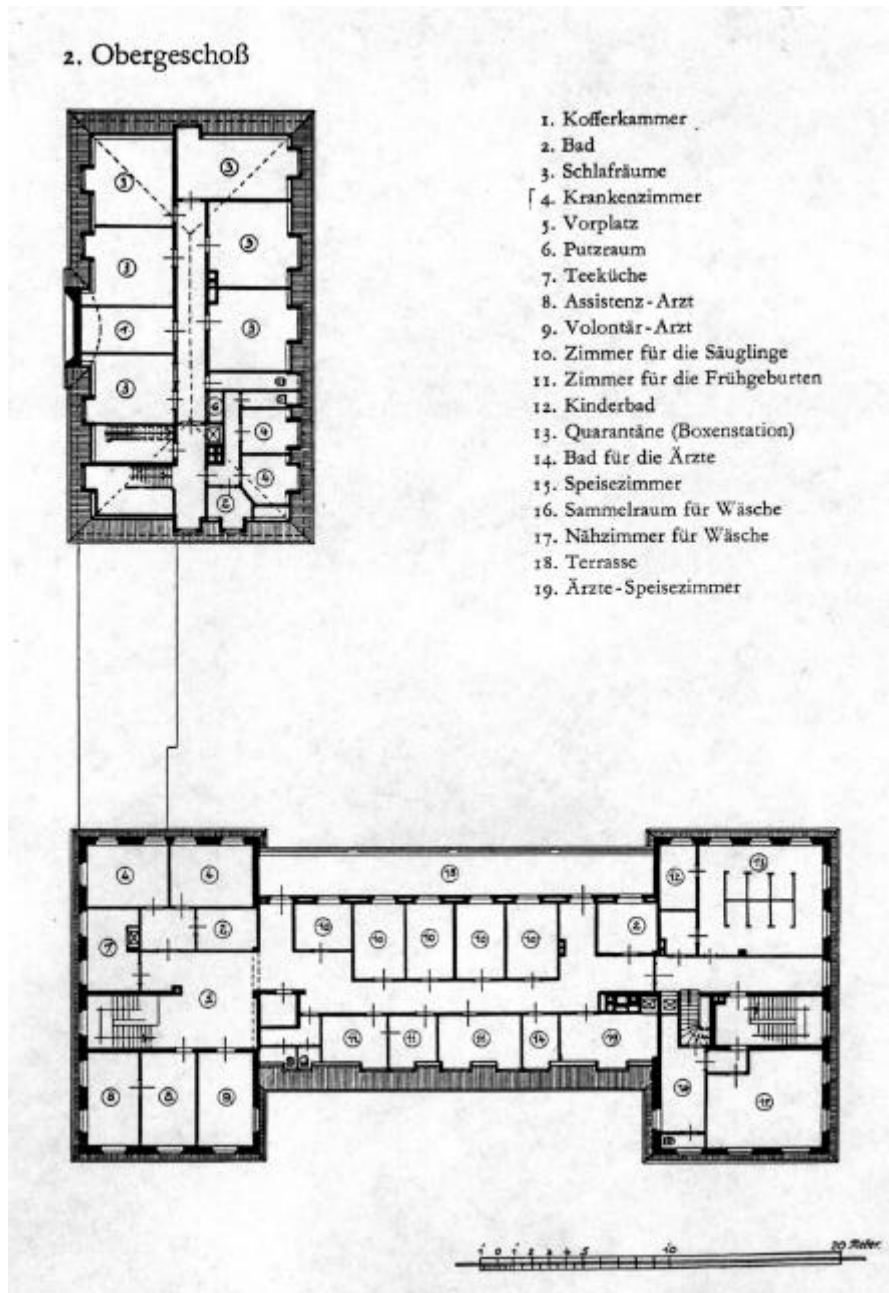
Grundriss 2. Obergeschoss (16,S.27) mit Erweiterungsbau aus dem Jahre 1913
